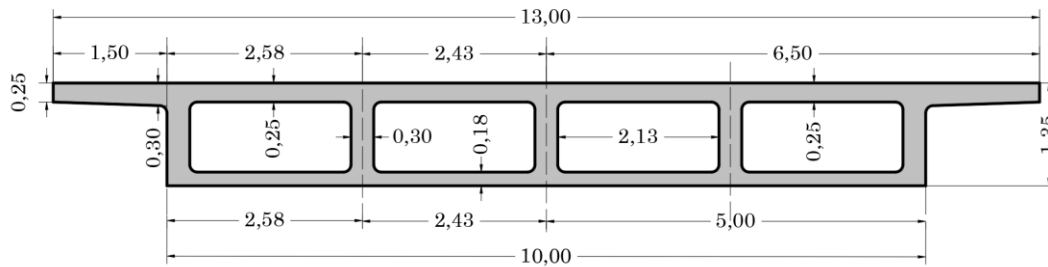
Sección transversal del puente sección cajón multicelular (Fuente: Elaboración propia).
